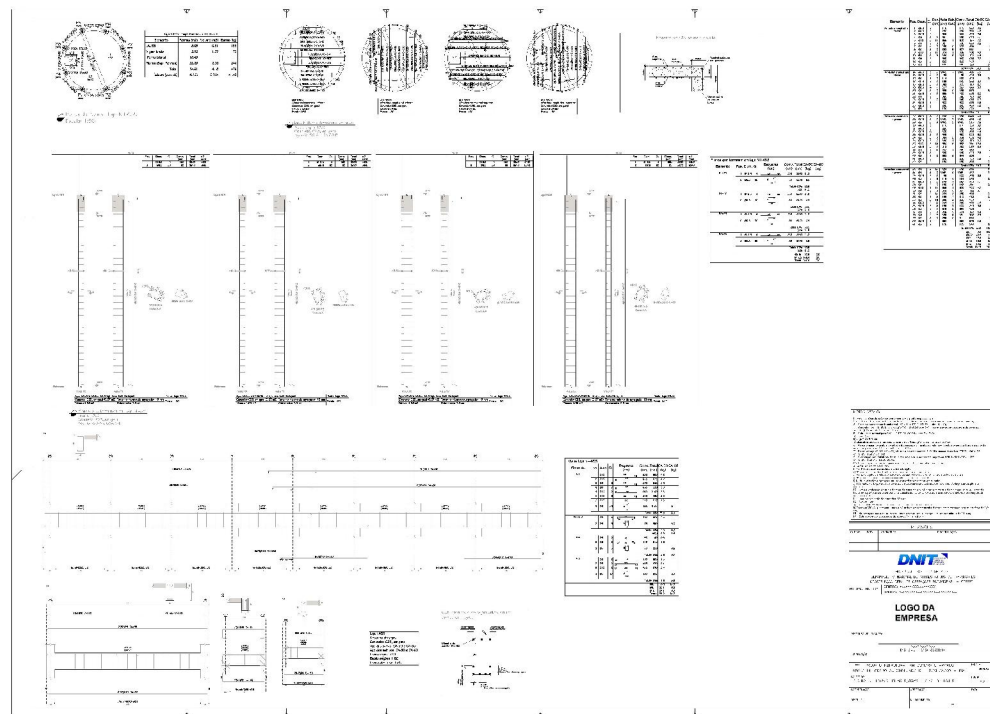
Planta de forma, pilares, vigas e arm. de lajes.
